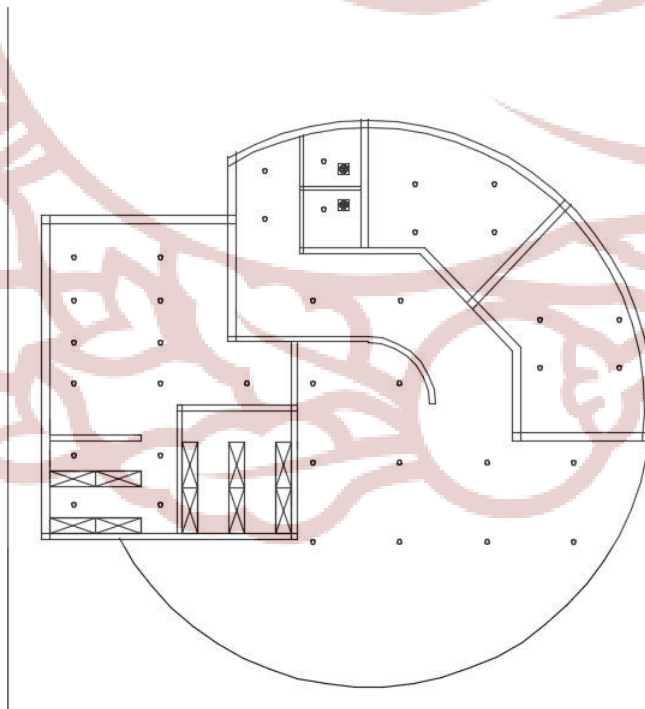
Rencana ceiling dan lighting restaurant Gubugklakah
